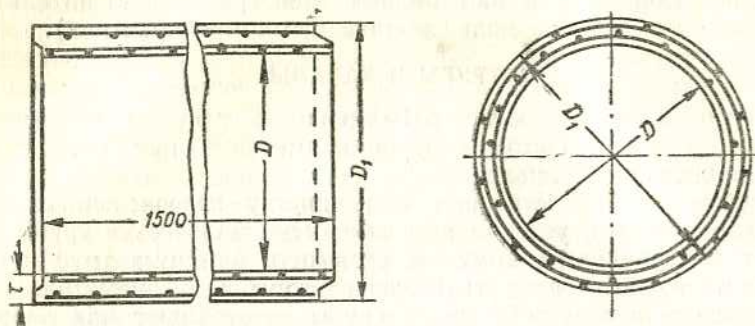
Трубы железобетонные звеновые безнапорные, изготавливаемые в инвентарной металлической опалубке
